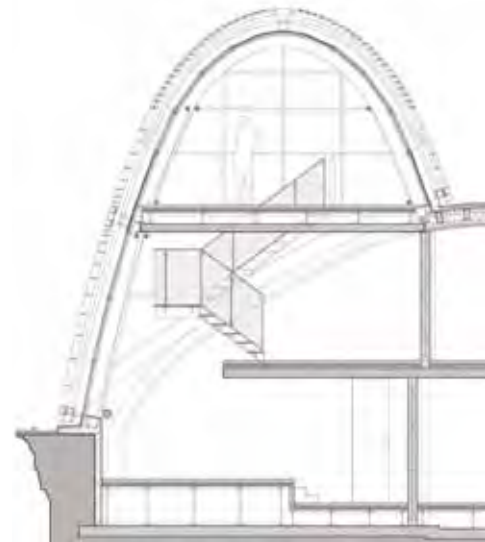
\_ Schnitt B-B © Silberpfeil Architekten
